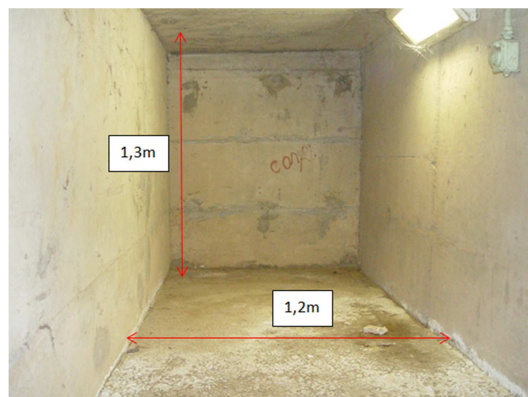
à esquerda: Vista interna da estrutura de ventilação (seção P-P de 6641-DC-00002)
